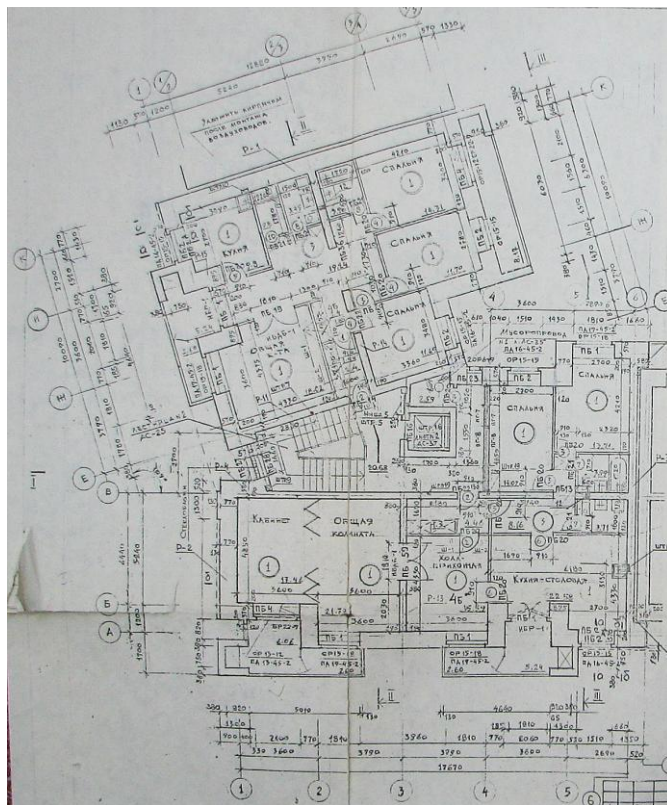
Дом-вставка по ул. Красная площадь, д. 3Б. План типового этажа
